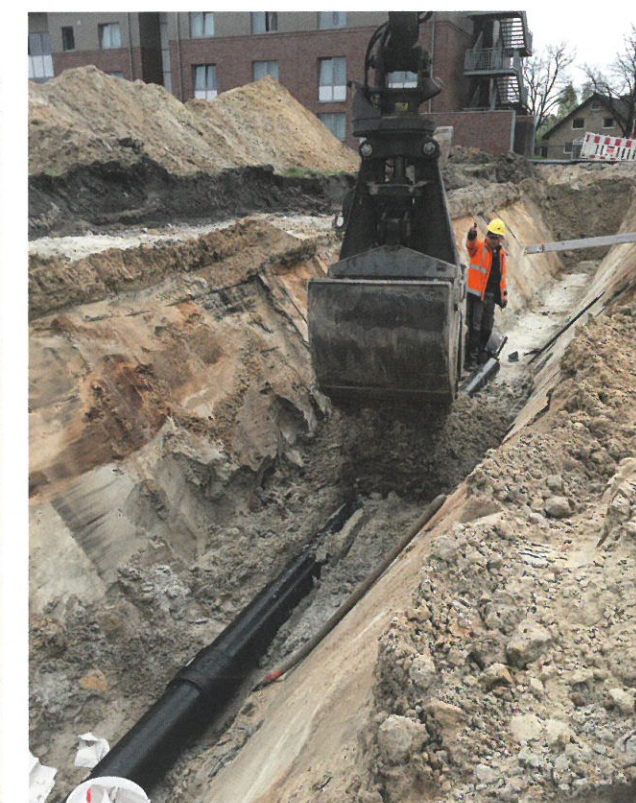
Vollgeschweißt bis zur Grundstücksgrenze: Die Grundstücksanschlussleitungen wurden mit dem PLASSON Betonschachtadapter und dem LightFit-Anschlusssattel mit flexibler Anschlussmuffe 0-12° zusammen geschweißt
